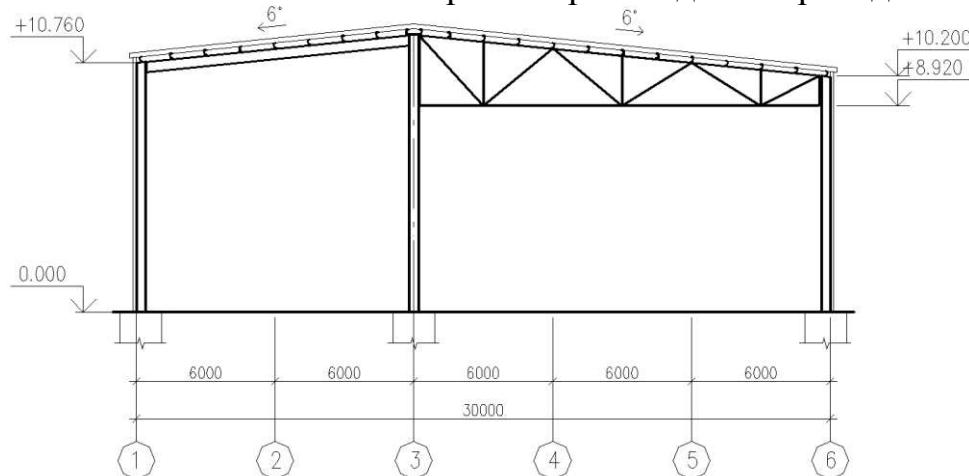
Компоновочная схема поперечной рамы здания
